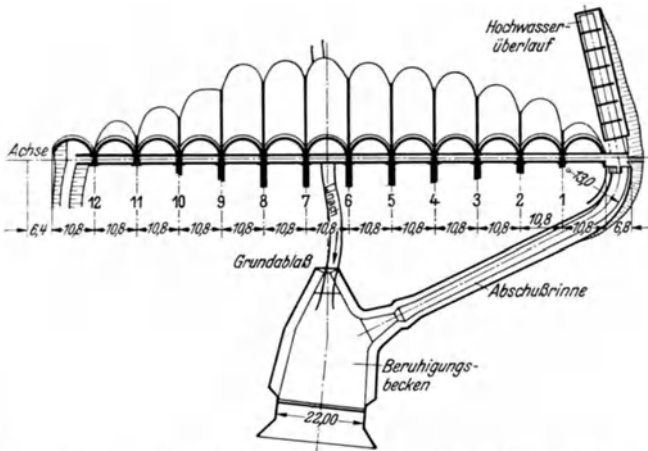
Pfeilerstaumauer Vöhrenbach. [Nach F. MEIER: Beton u. Eisen 23 (1924) S. 13.]
